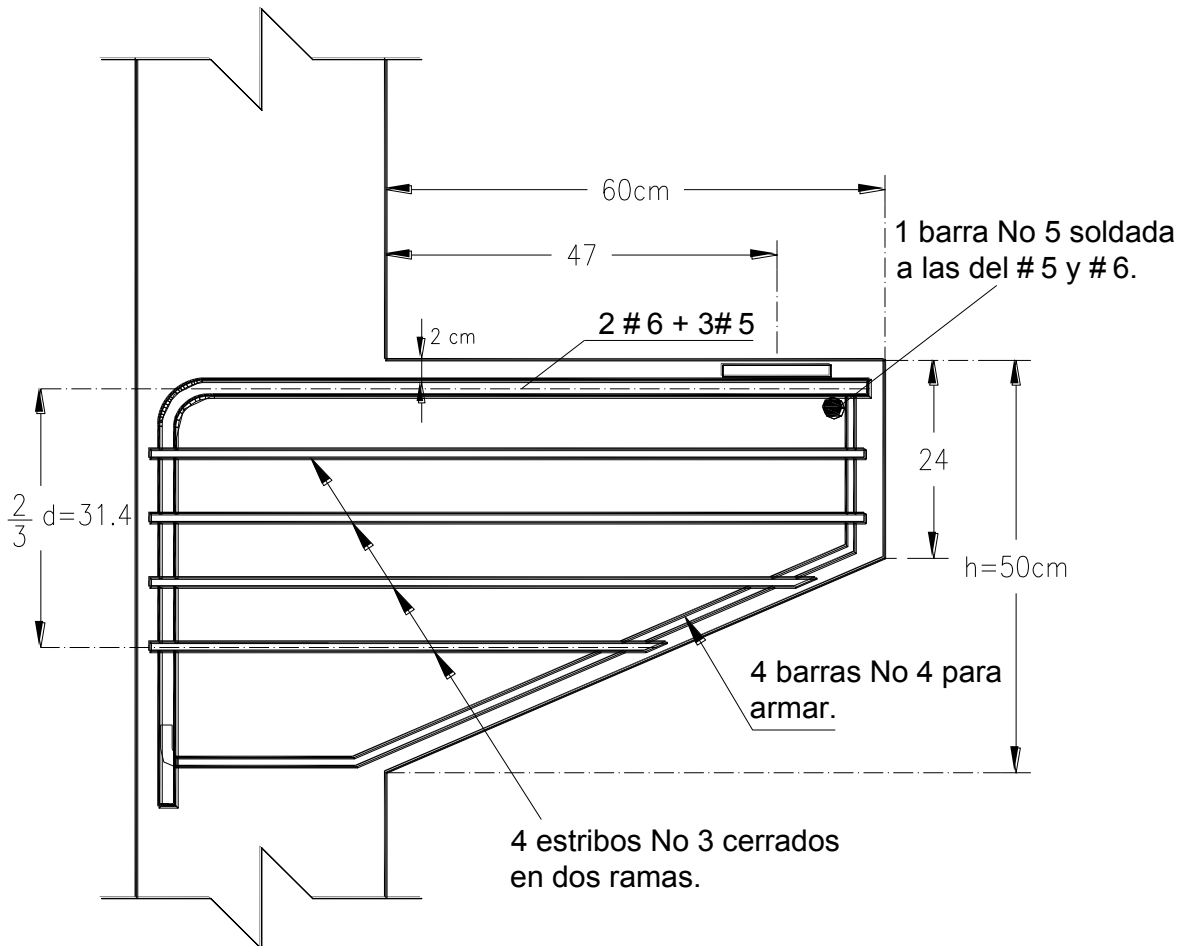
Refuerzo propuesto para la ménsula.
